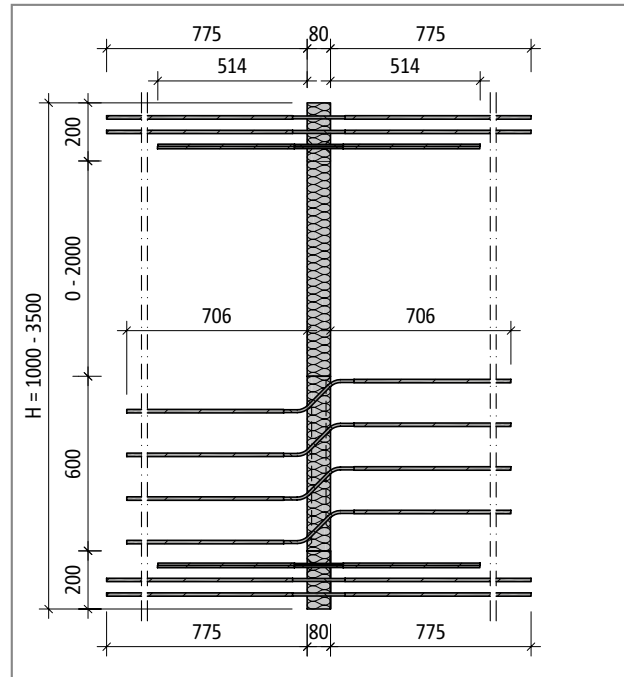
Schöck Isokorb® tip W10S: tloris proizvodna
